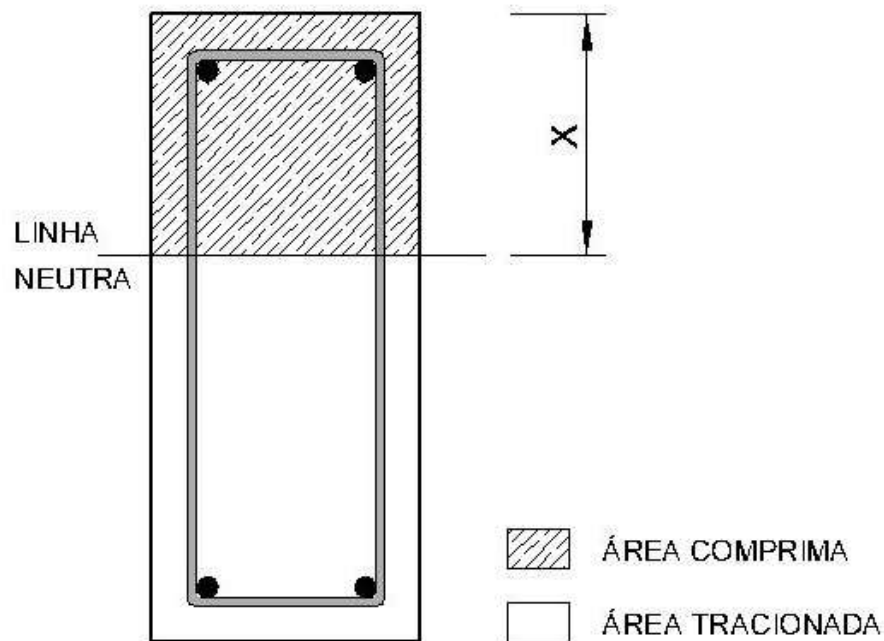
Dimensões da seção transversal de uma viga retangular.
